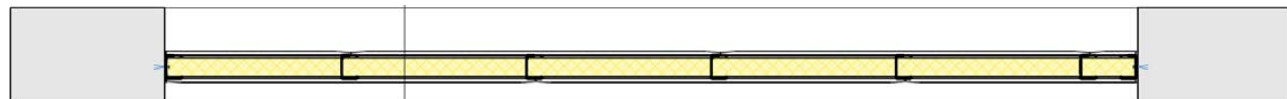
bovenaanzicht van meting nr. 4 met wandconstructie GF 100/1.75.1.A
